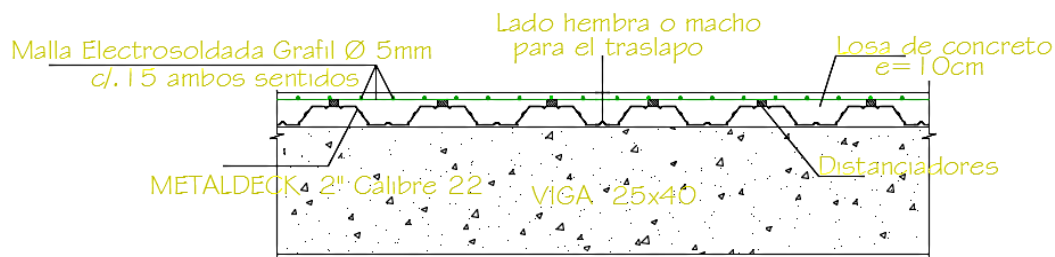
Corte típico de la placa de entepiso Zona A, Mezzanine. Fuente:
